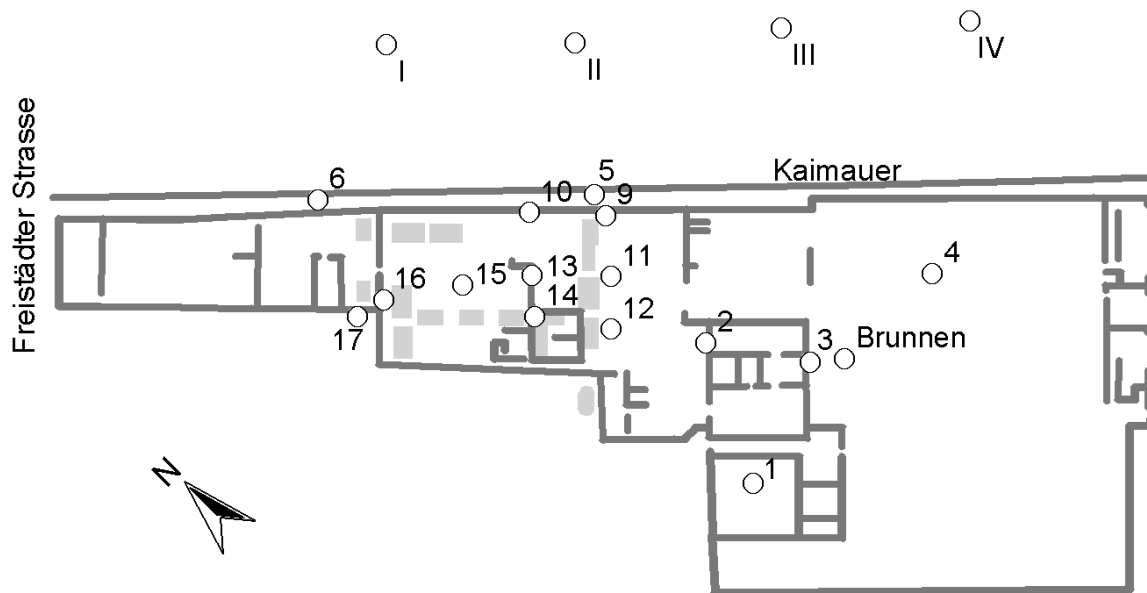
Lageplan des Betriebsgebäudes der Fa. Wozabal mit Bodenluftabsaugstellen (1 – 17), Grundwassersonden (I – IV) und Betriebsbrunnen
